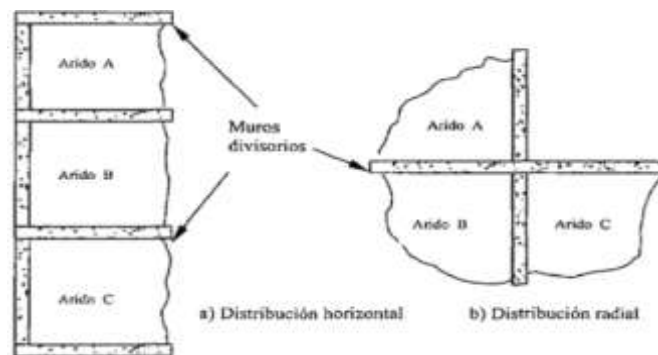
Distribución en planta del almacenamiento de áridos.
